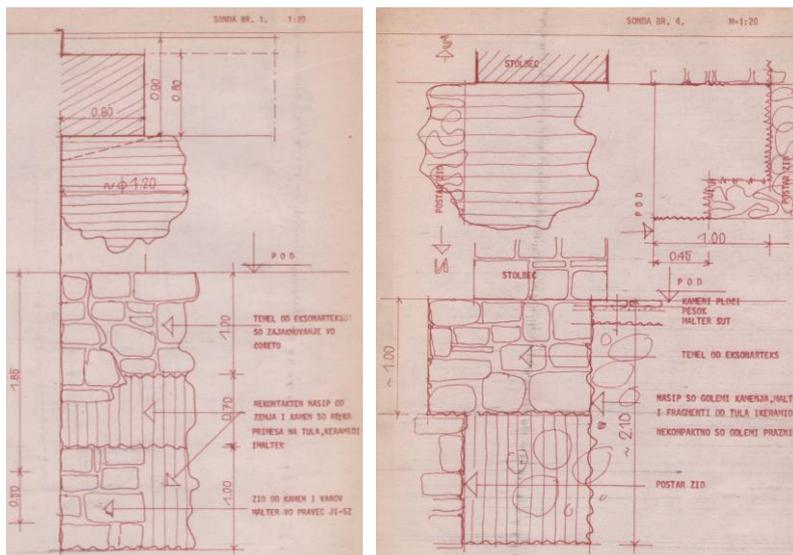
Las sondas geo-mecánicas 1 y 4. Planta y sección.
